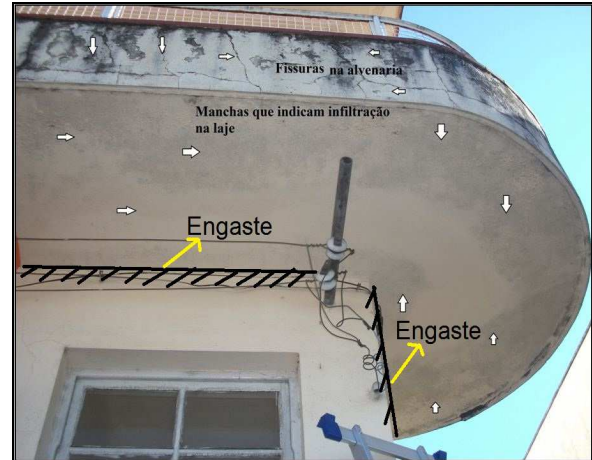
Fissuras e deslocamento do concreto na sacada acima da marquise M3
